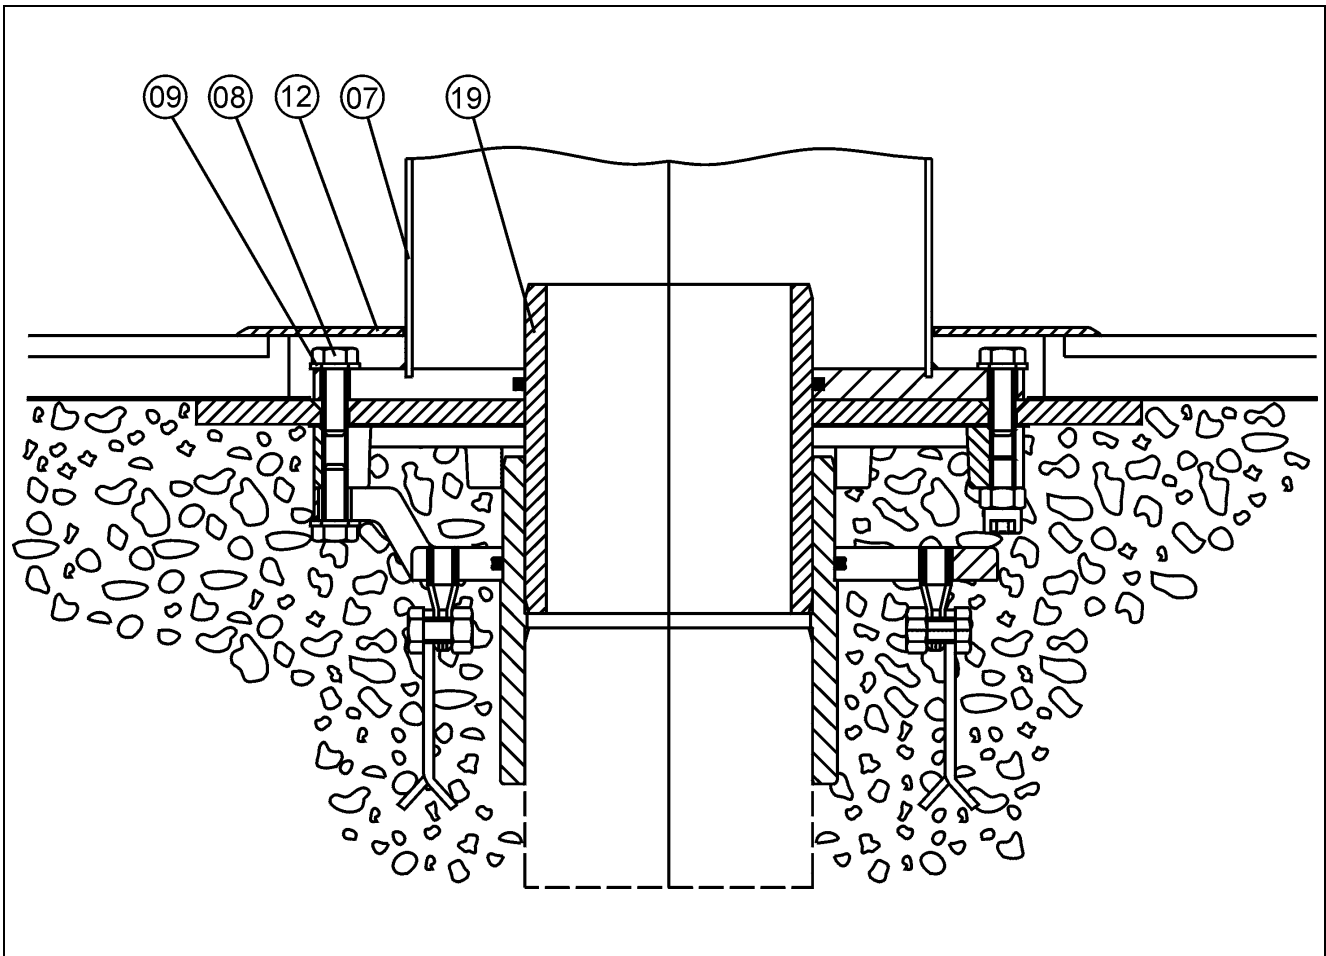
Bassin béton avec étanchéité souple / amenée d'eau verticale
